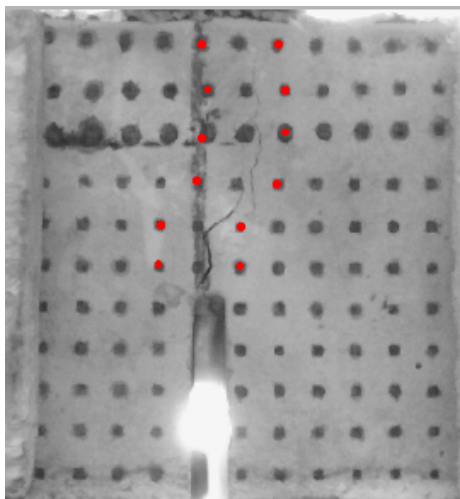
Caminho da trinca para a viga V1 do concreto C25d25F26
